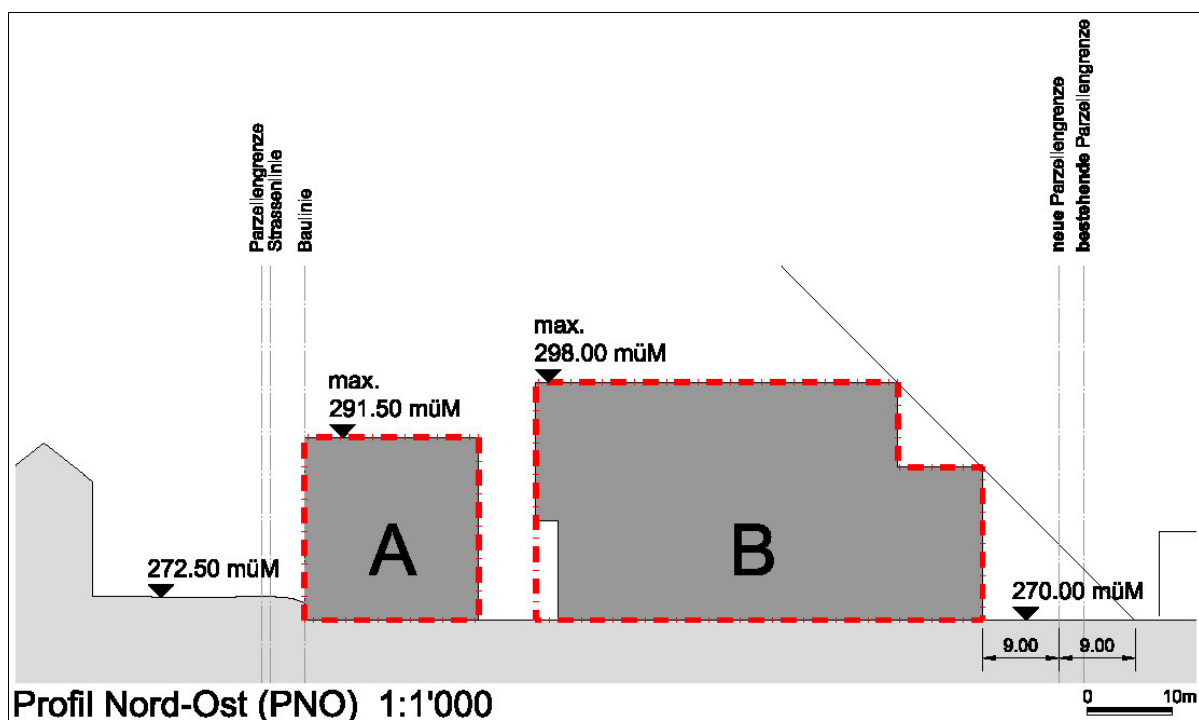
Plan-Nr. 13'191. Bebauungsplan: Profil Nord-Ost (kein Massstab)
